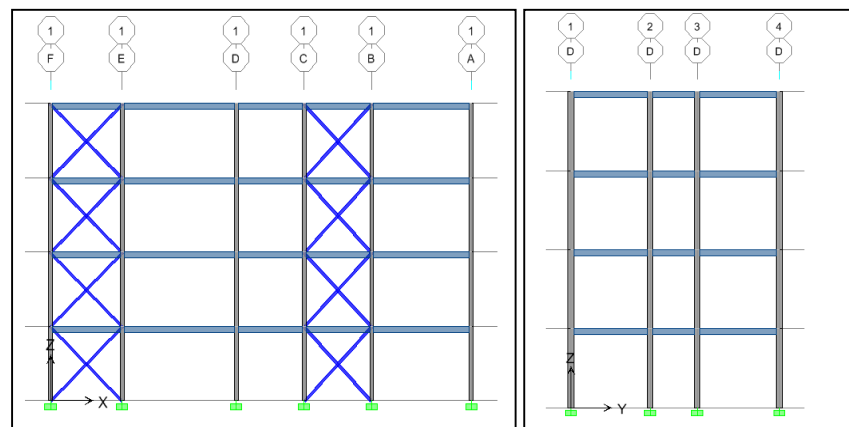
Elevación pórtico 1 y pórtico D respectivamente
